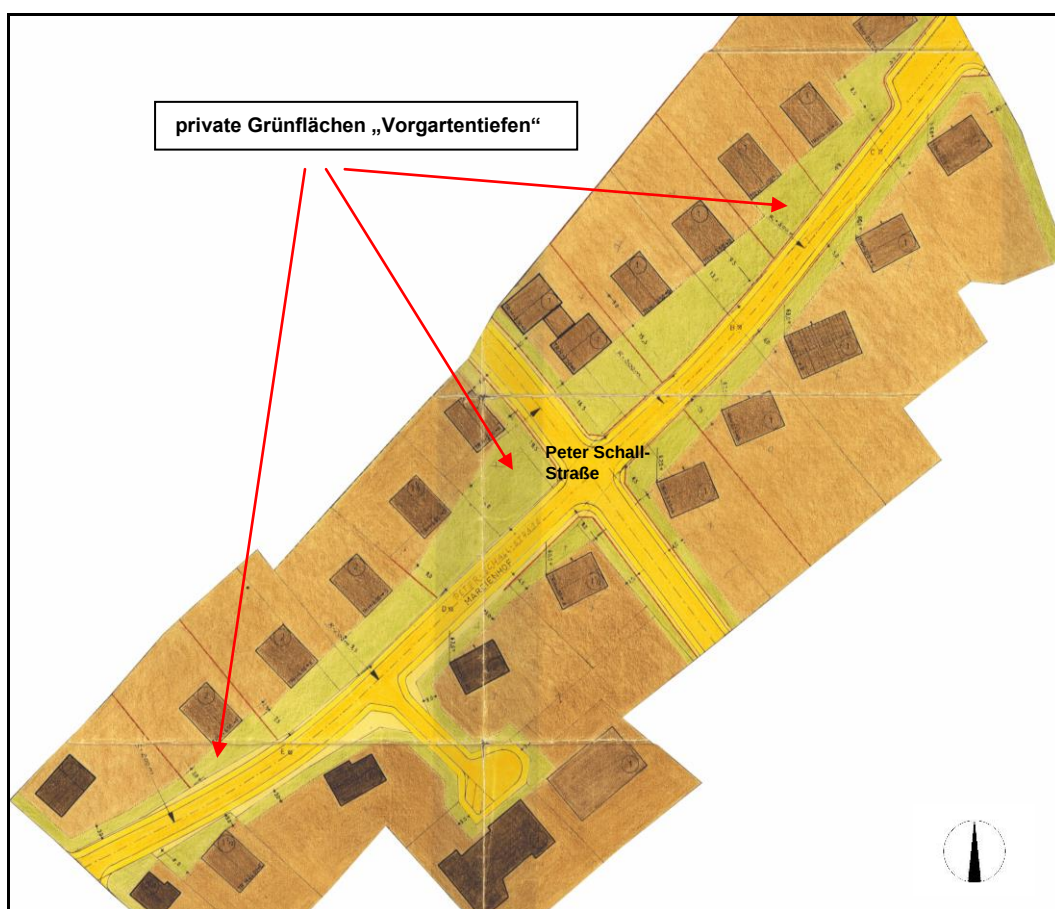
Ausschnitt der Planzeichnung B-Plan „Mareienhof“
